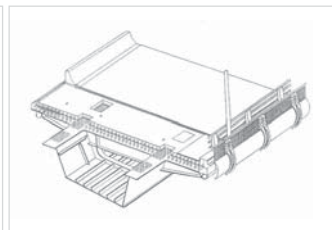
Stanowisko scalania konstrukcji stalowej, odcinek przeznaczony do betonowania płyty oraz część zabetonowanej i już przesuniętej konstrukcji
